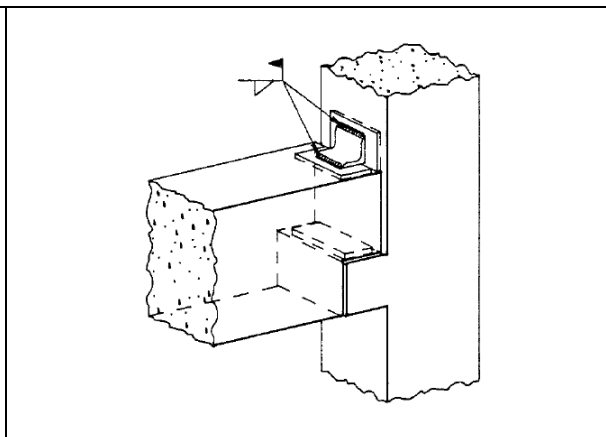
Ligação por consola curta com chapas soldadas (Sidney, 2000)
